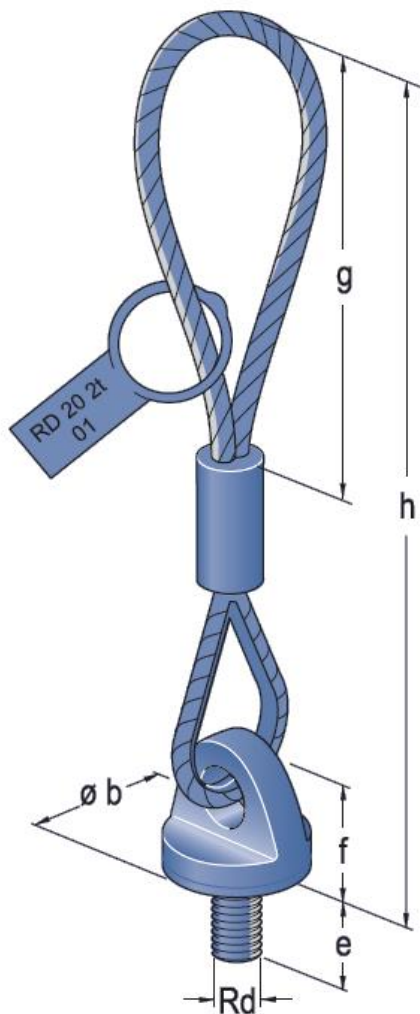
Подъёмное приспособление из проволочного каната с прижимной деталью
